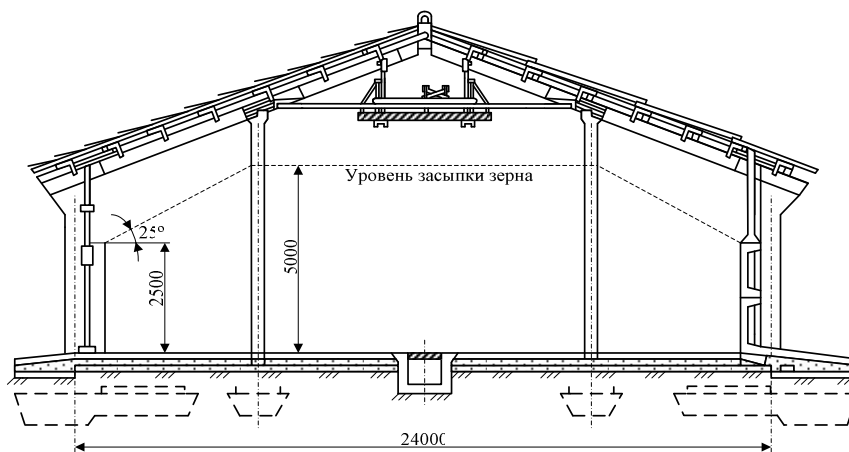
Типовой механизированный зерновой склад из сборного железобетона без заглубления пола
